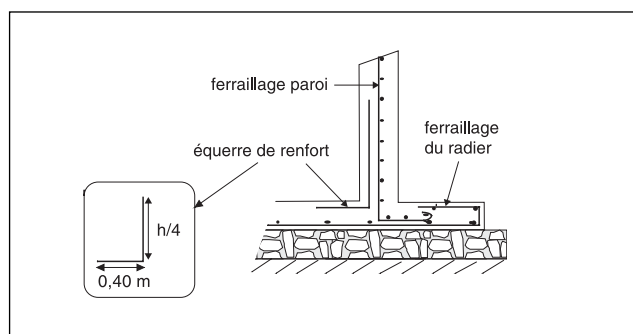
Ferrailage des parois d'un réservoir rectangulaire de capacité importante (vue en coupe verticale).
